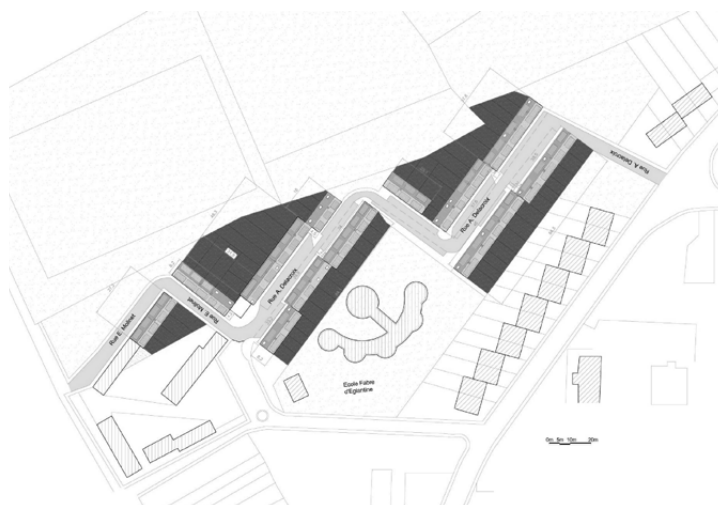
Planta emplazamiento Chemin vert à Boulogne-sur-Mer. Fuente: Construire (2013)
